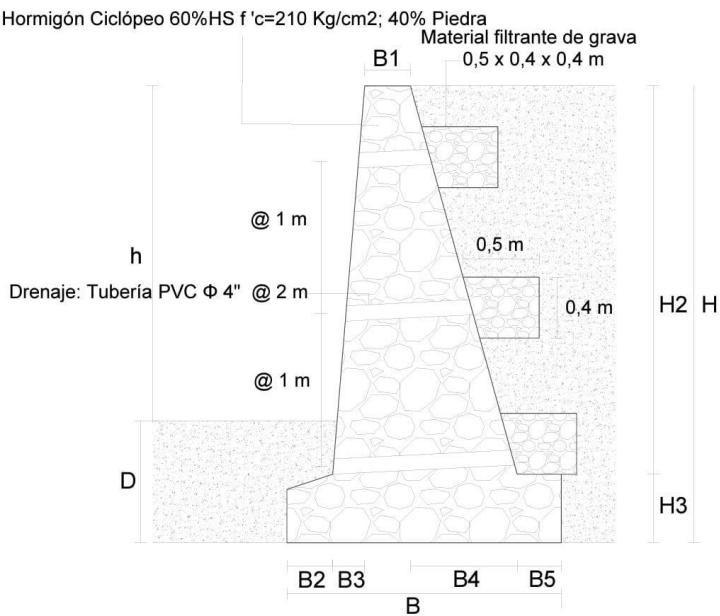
Esquema de las dimensiones del muro de gravedad y detalle de sistema de drenaje.
